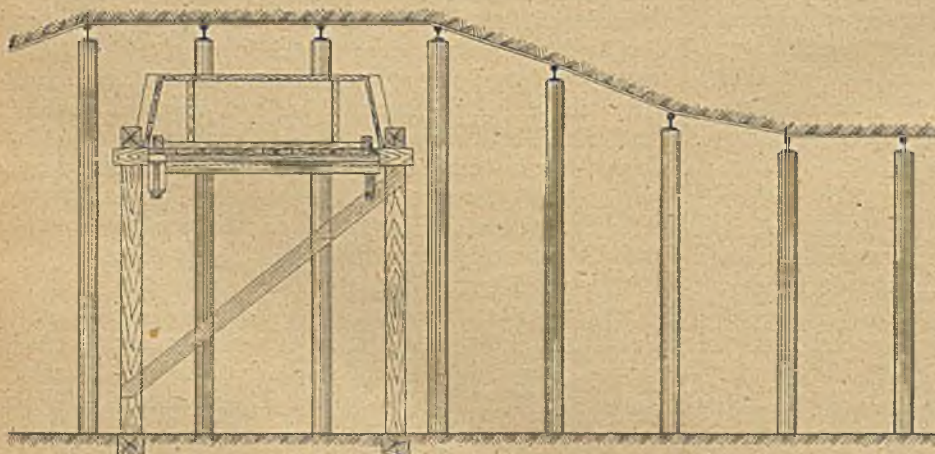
Streckenlängsschnitt mit eingebautem Gesteinstaubbruch von niedriger Bauart.
